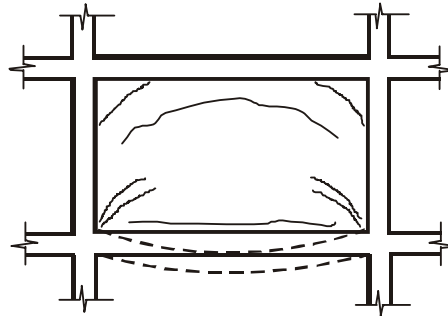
fissuras em parede de vedação por deformação da viga de apoio (DUARTE, 1998)
